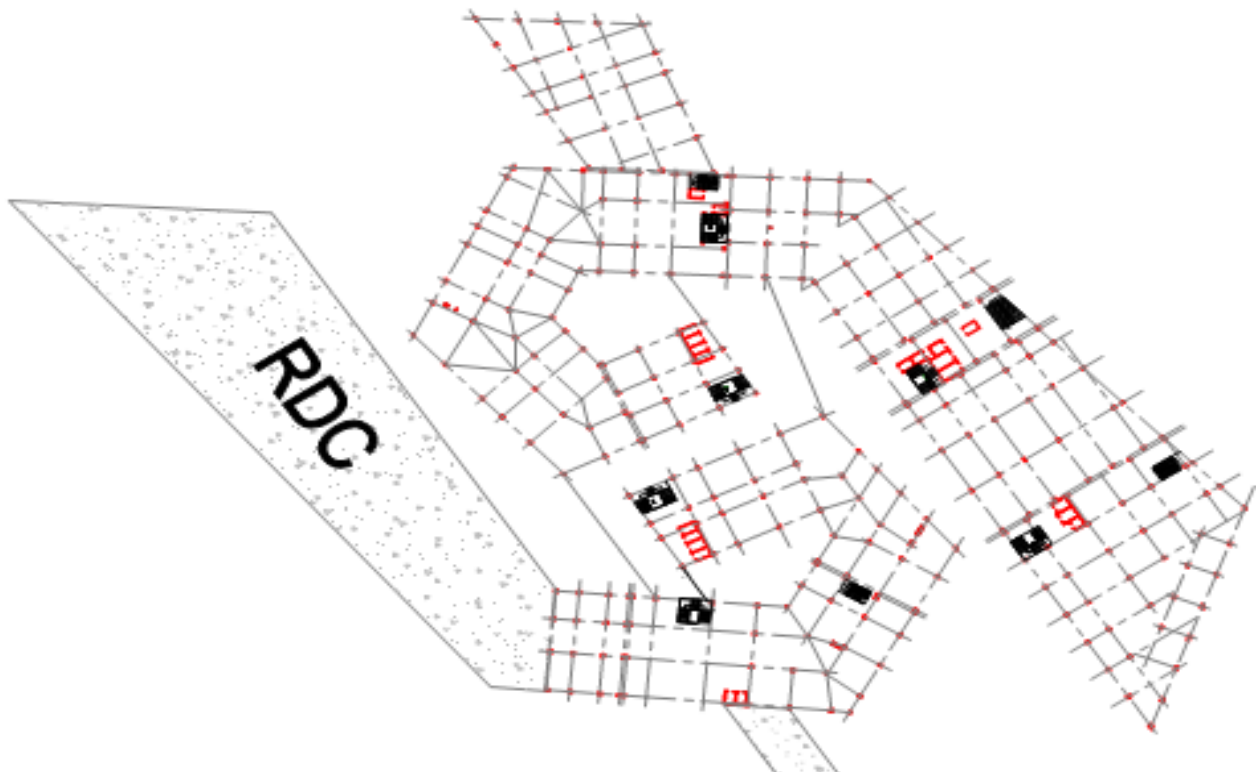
schéma de structure plan 1^{er} étage source : auteur
